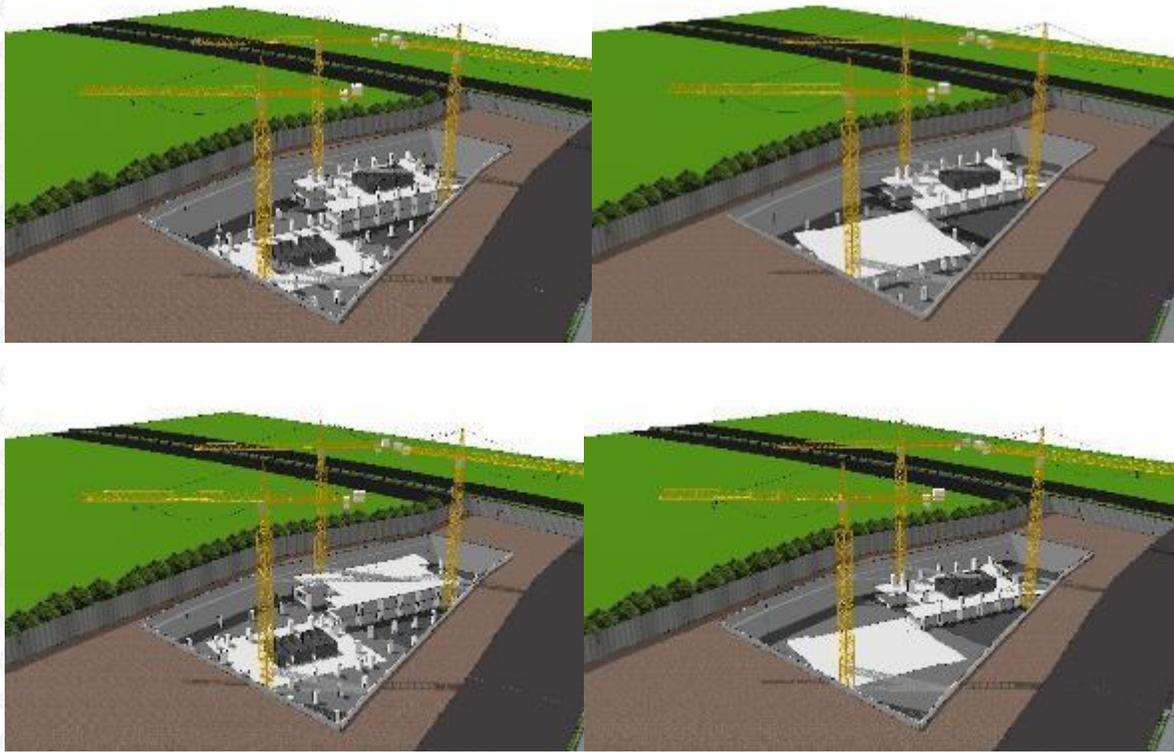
Mulai Pengecoran Tower Emerald North
